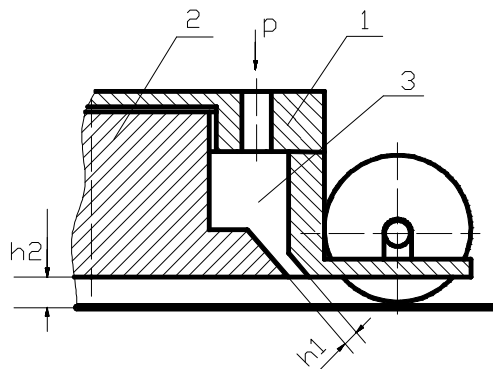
Конструктивна схема струменевого живильника з кінчною щілиною
